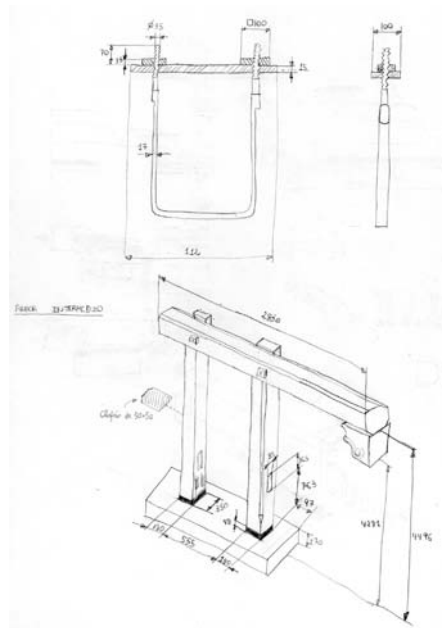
Croquis del zuncho de hierro que une las vigas y del árbol guía intermedio
